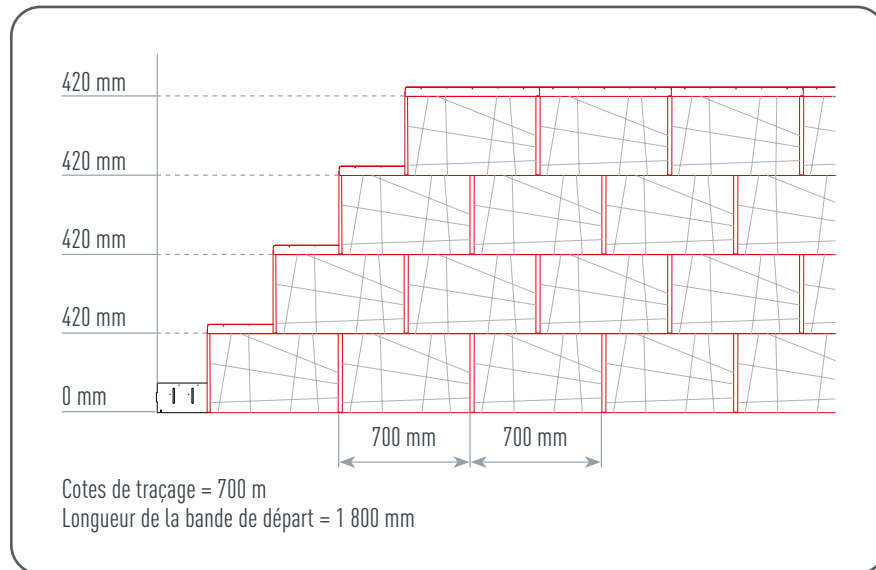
• Cotes de traçage pour les panneaux de toiture FX.12
